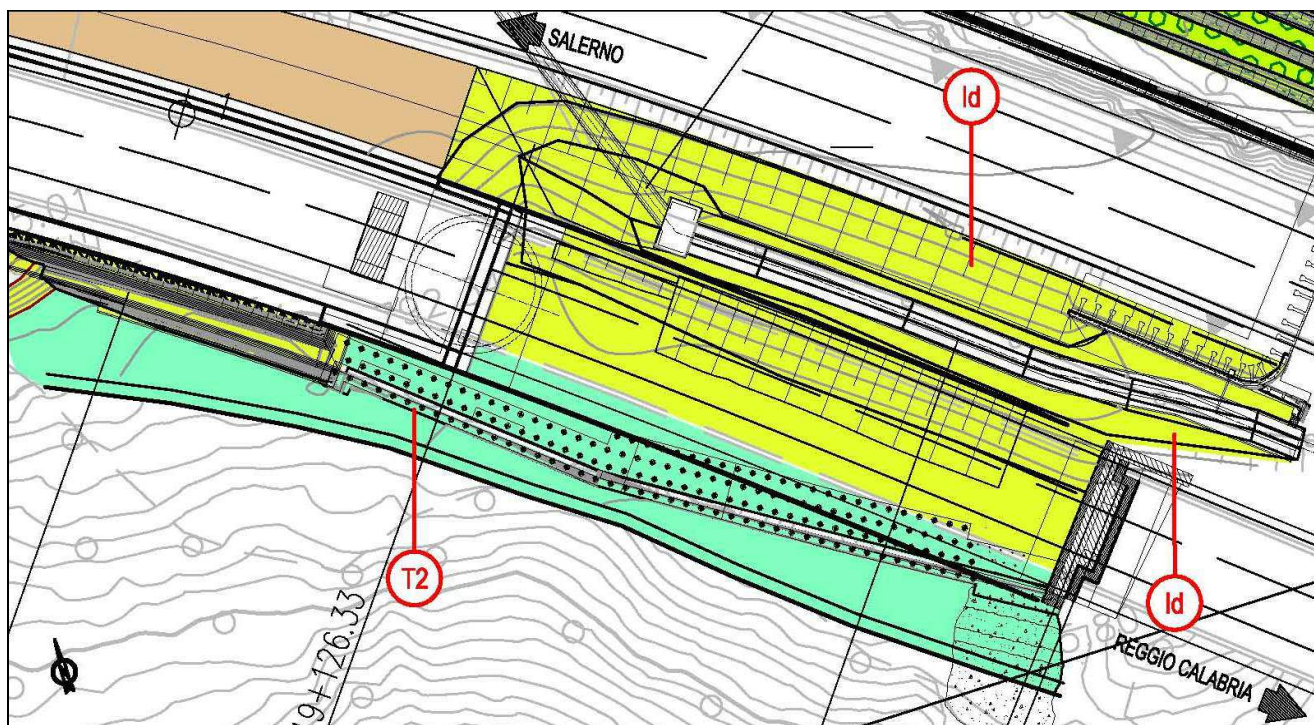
Stralcio planimetrico delle opere di mitigazione ambientale
